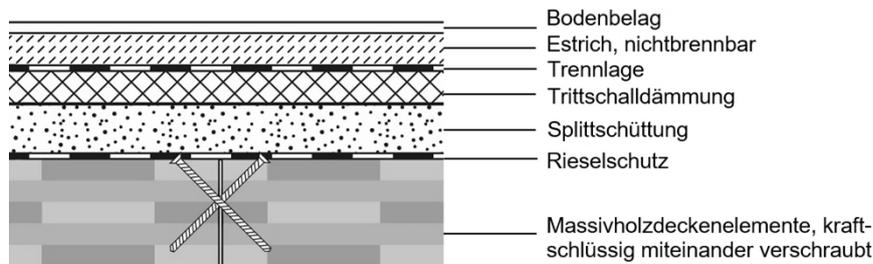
unbelagte Massivholzdecke mit verschraubter Elementfuge und mehrlagigen Fußbodenaufbau (Vertikalschnitt) [Muster-Richtlinie 23.05.19]
